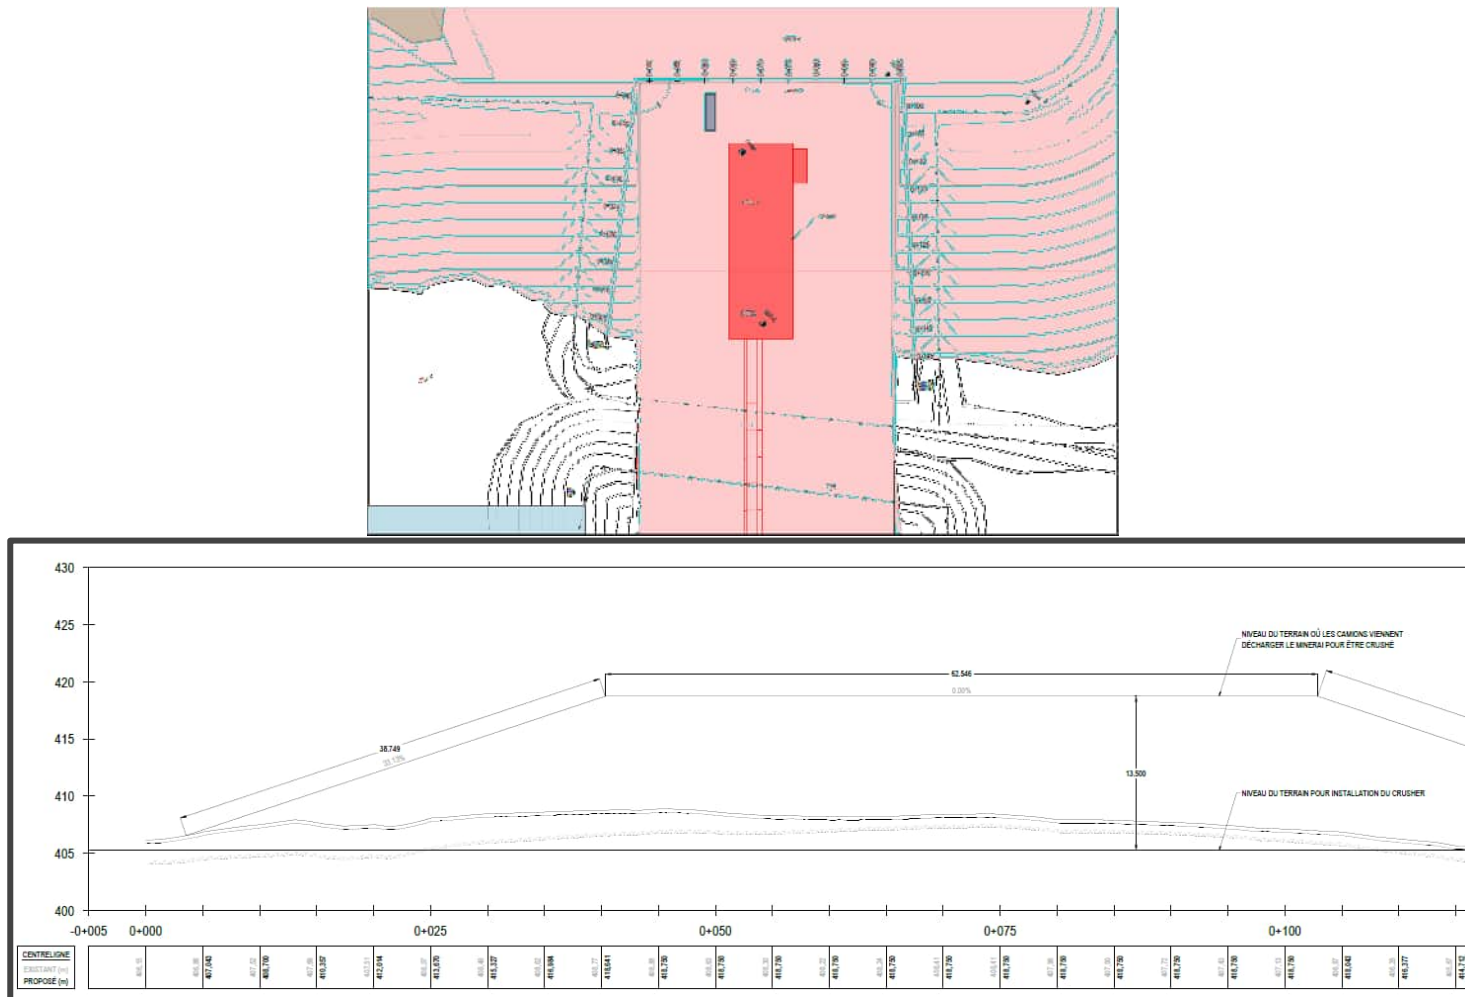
Exemple de coupe transversale à l'intérieur de la zone d'excavation du complexe multiservice (adapté de Windfall Mining Group, comm. pers., 6 mars 2023, nom du fichier « proposed_mur_soutenement_2022-10-05.pdf ») »
